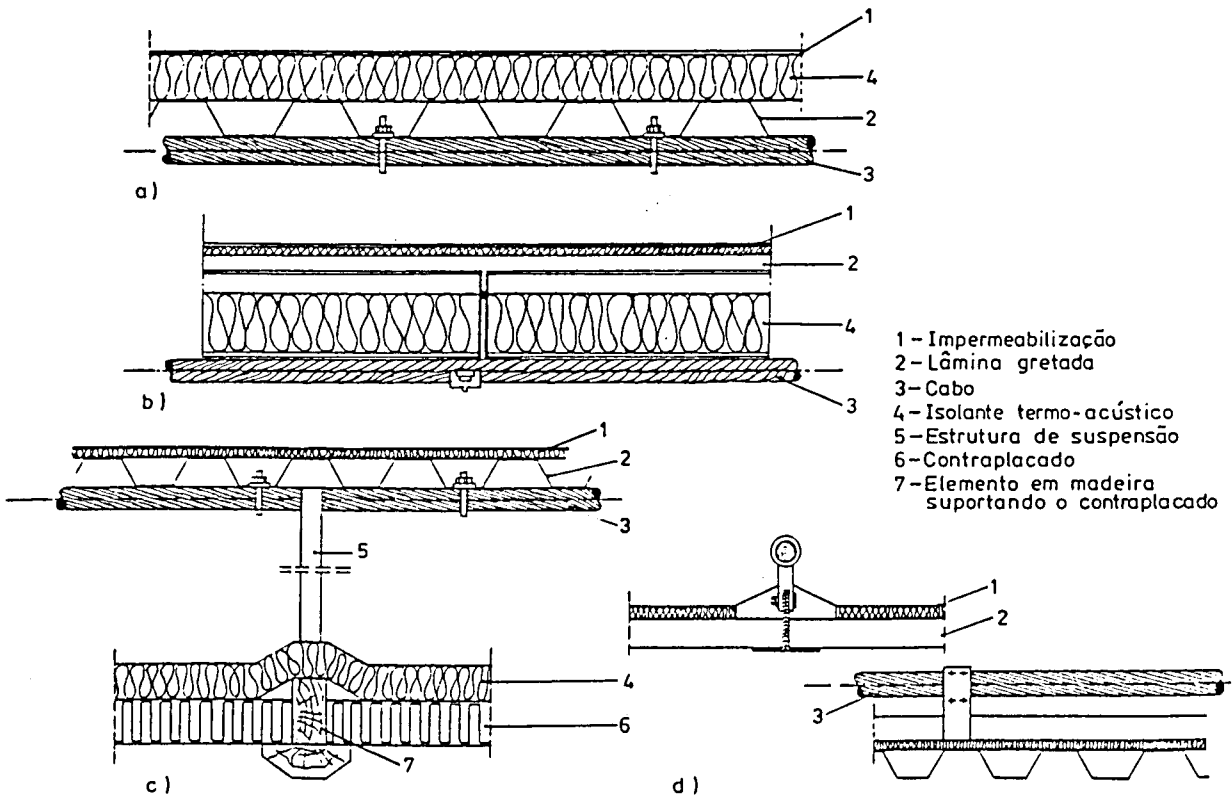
União de uma cobertura de lâmina gretada a um sistema de cabos: a) com grampo; b) com um perfil metálico; c) com a colocação inferior do isolante; d) inferiormente.
